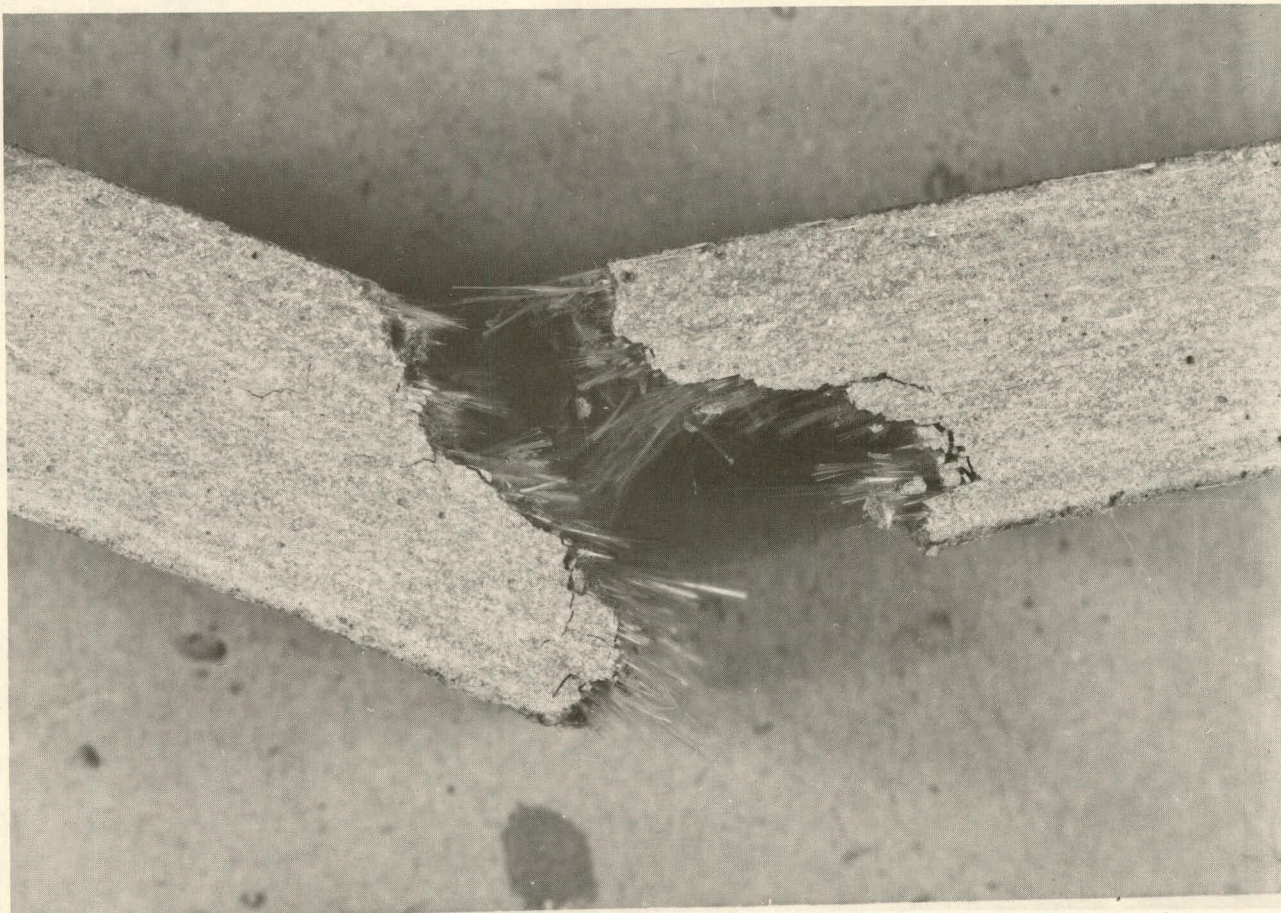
Spécimen en béton renforcé de fibres de verre
